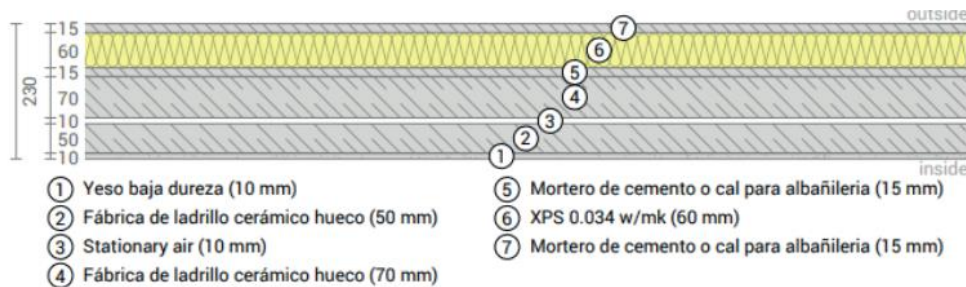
Detalle de la solución constructiva de la fachada tras aplicación de la medida
